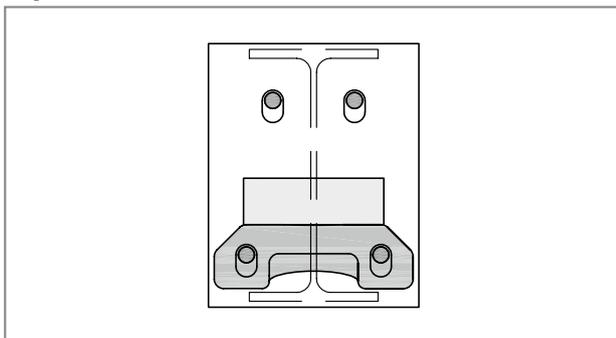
Schöck Isokorb® T type SK : le taquet fourni par le maître d'ouvrage se trouve directement sur la plaque d'absorption de la charge
